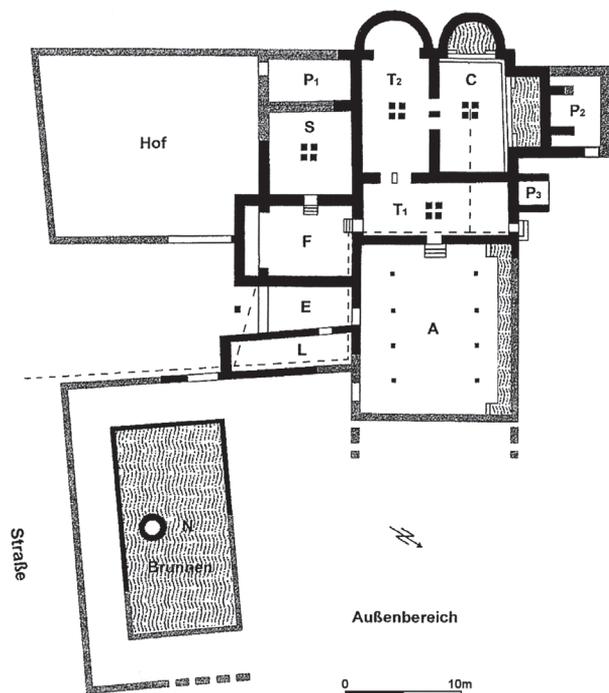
Grundrissplan Bauphase 3 mit Außenanlagen.
